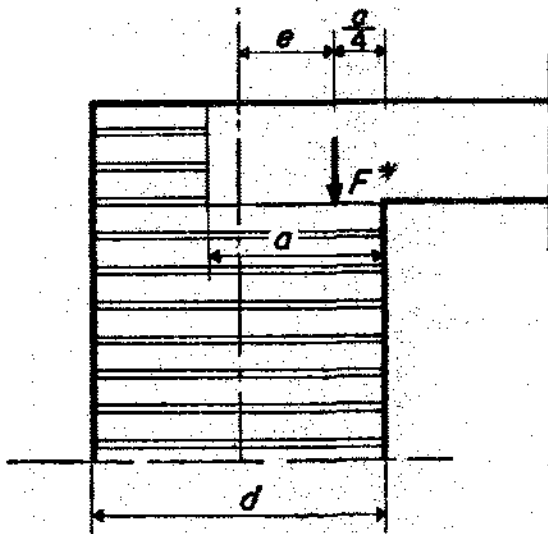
Forjado sustentado en un muro extremo, sin muro de carga sobre el forjado
